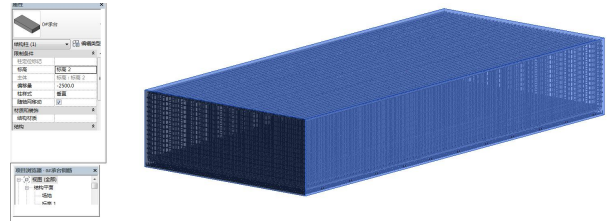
0号承台钢筋混凝土BIM模型展示内部钢筋数量并进行工程数量复核
